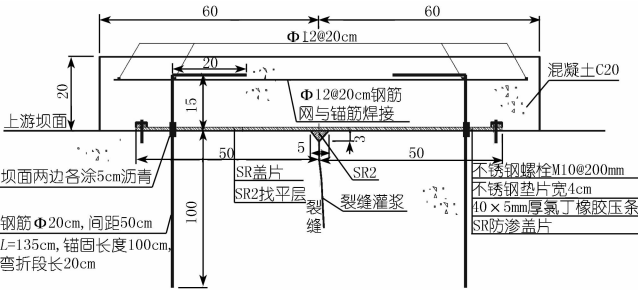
裂缝外贴处理构造示意(尺寸单位:cm)
